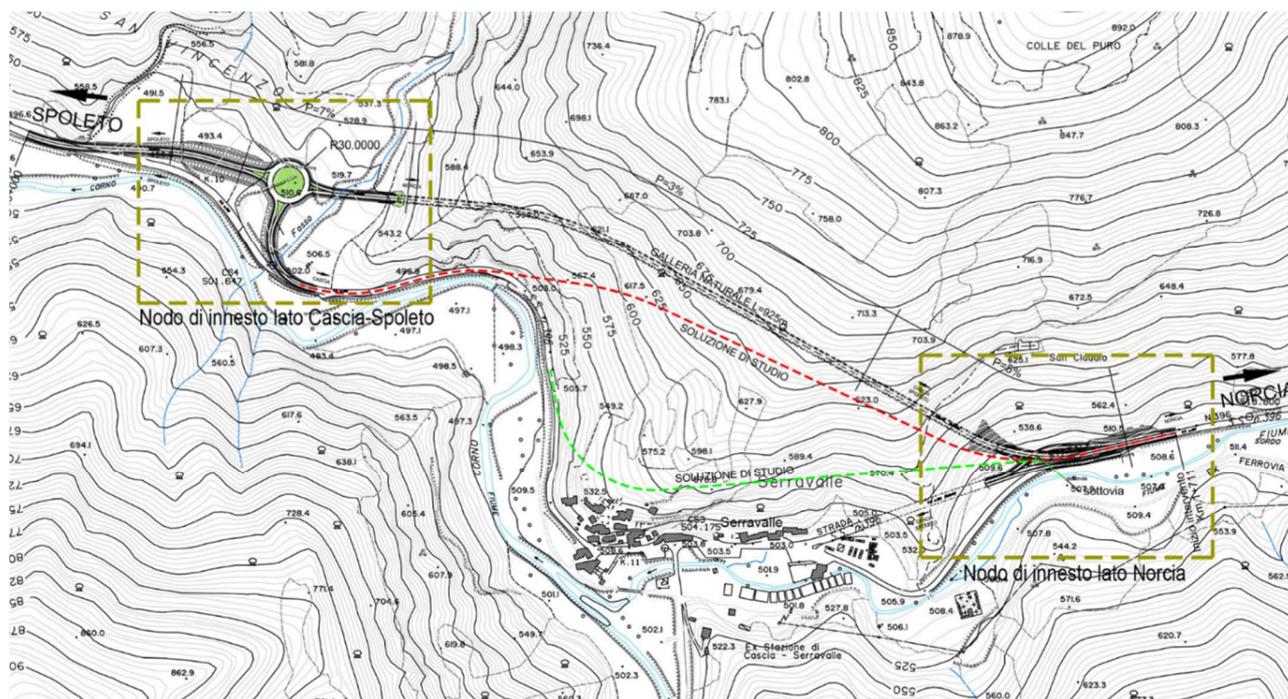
Estratto PRG, Parte Strutturale – Progetto viabilità variante di Serravalle
